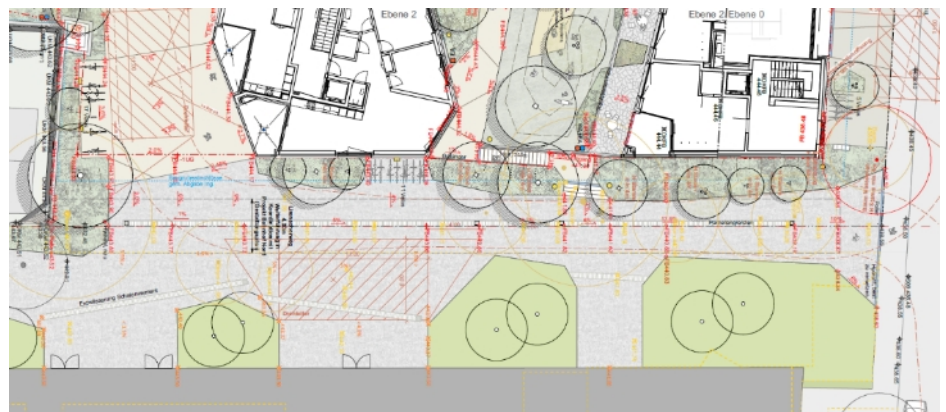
Ausschnitt Feuerwehrezufahrt und Quartierweg, Überbauung am Stadtplatz, 29. Juni 2020
